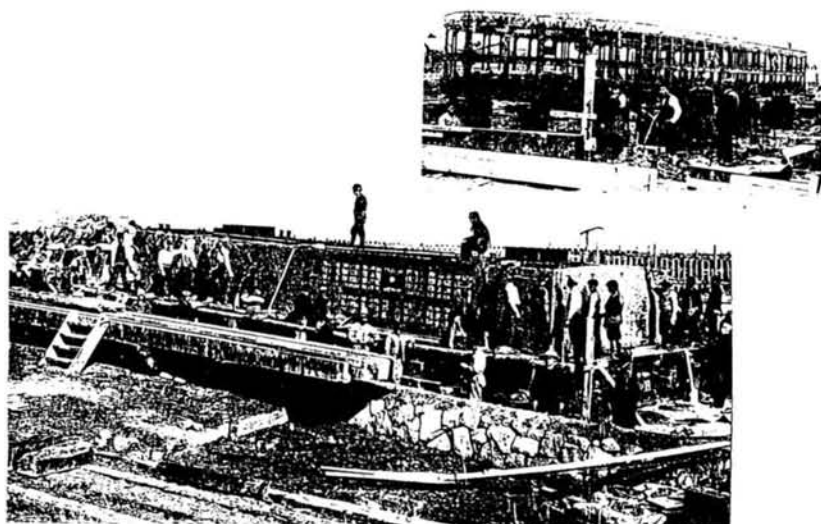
大阪築港、鉄筋コンクリート製土運搬船
